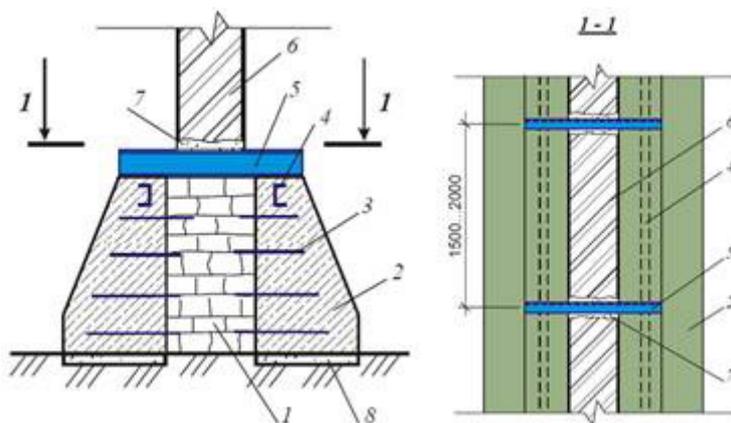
Усиление монолитного ленточного фундамента уширением основания с использованием монолитных бетонных банкетов: 1 – фундамент; 2 – монолитный бетонный банкет; 3 – анкера; 4 – распределительная балка; 5 – опорная балка; 6 – стена; 7 – запеканка цементно-песчаным раствором; 8 – основание
